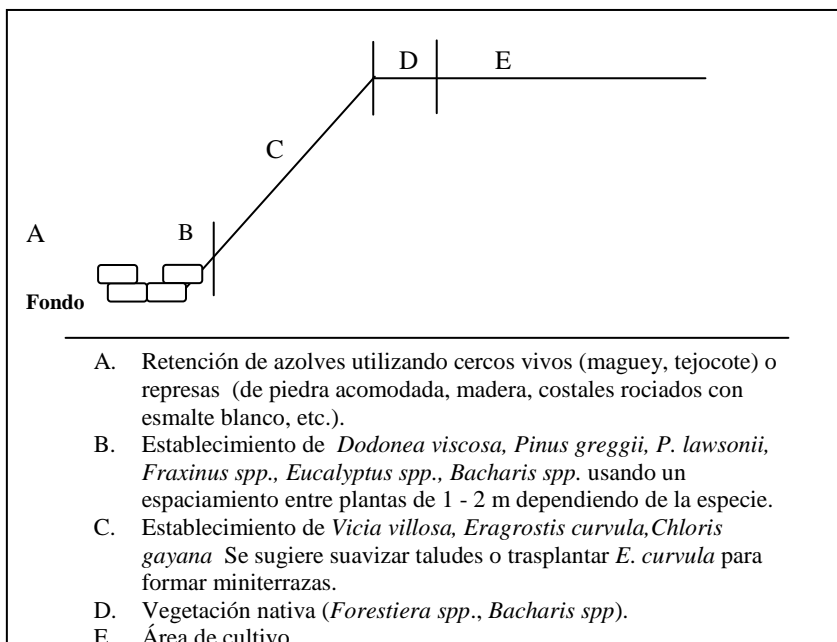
Perfil de la estabilización de un talud (modificado de Bravo *et al.*, 2008).
